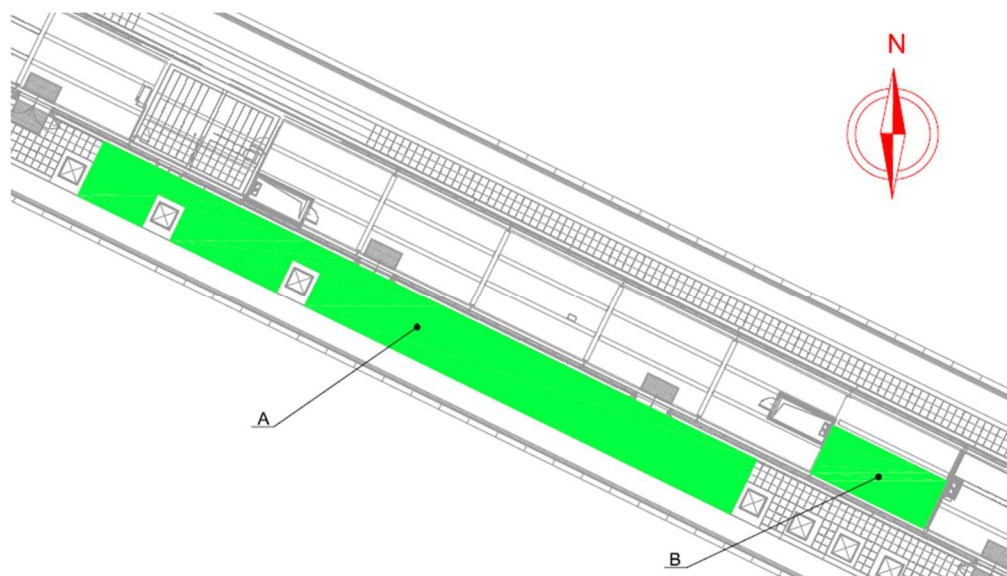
planimetria del luogo in cui è montato l'impianto.
